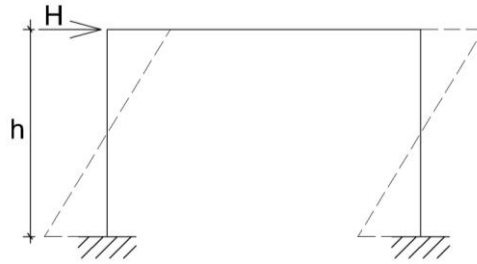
Moment încovoietor pe schema cadrului din beton armat
